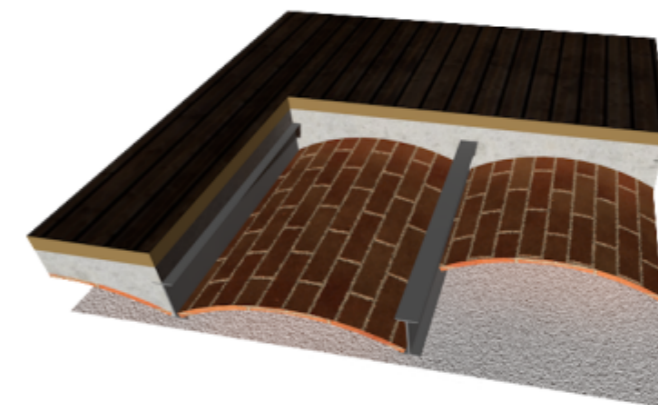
Imagen creativa de forjado de vigueta metálica con entrevigado de revoltón e ladrillo macizo y relleno de hormigón
